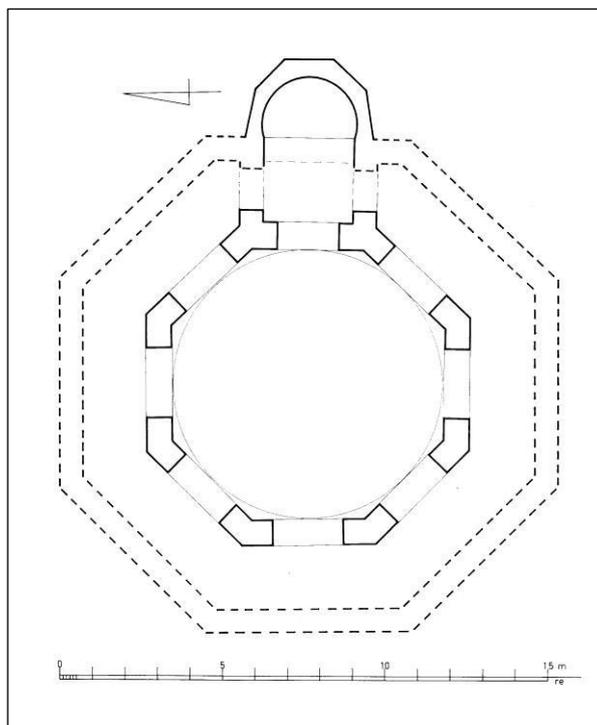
Pianta dell'edificio ottagonale proposta da Restle (RESTLE 1979, pl 46).
